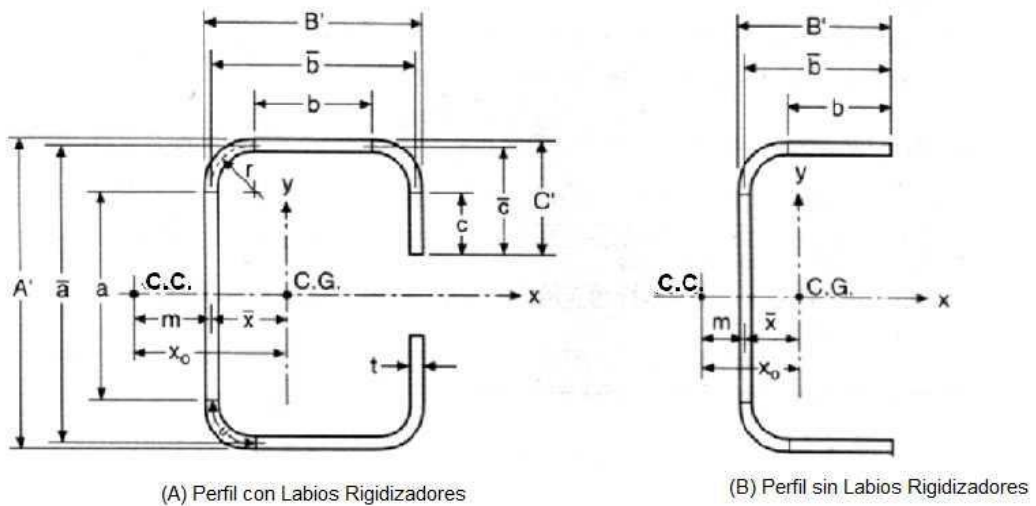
1. Secciones abiertas con simetría simple con y sin labios rigidizadores.
